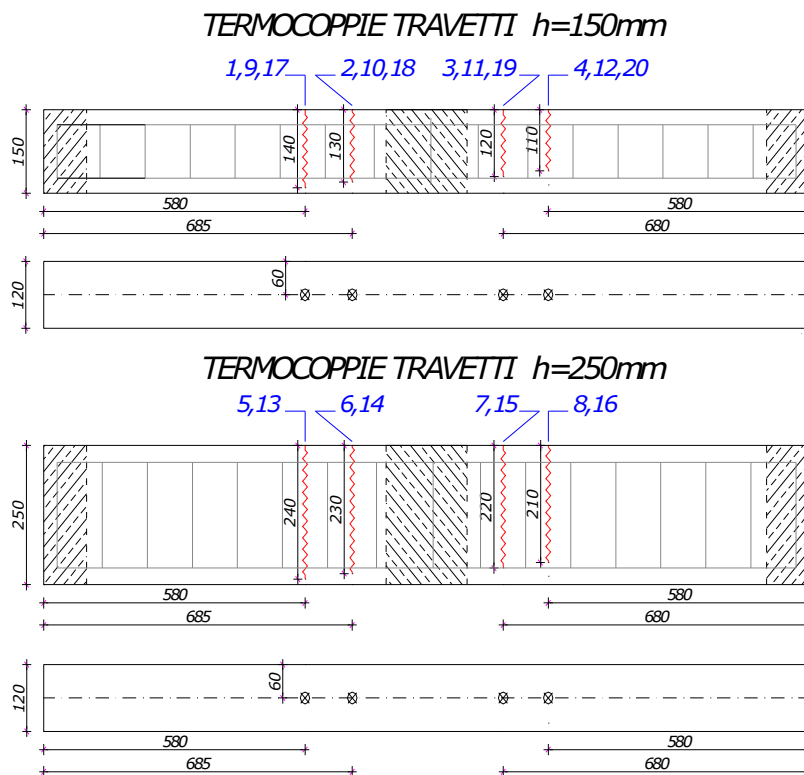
vista prospettica ed in pianta della collocazione delle termocoppie sui primi 5 provini.
